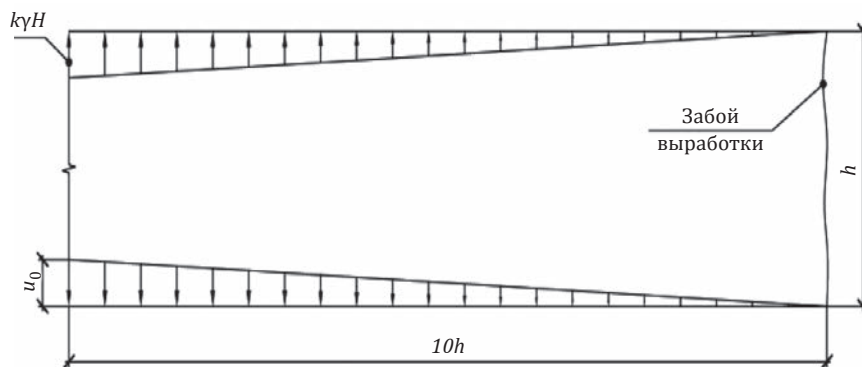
Расчетная схема к определению перемещения контура продольного сечения выработки.
